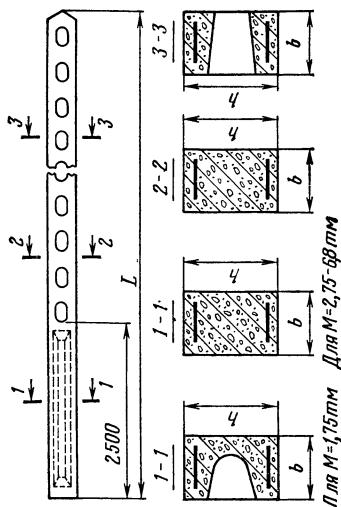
Железобетонные опоры типа ПО и ПОН
